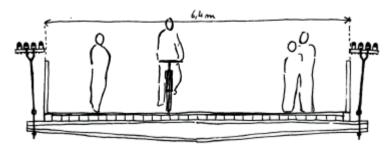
Choix du traitement du profil en travers, croquis RL&A
